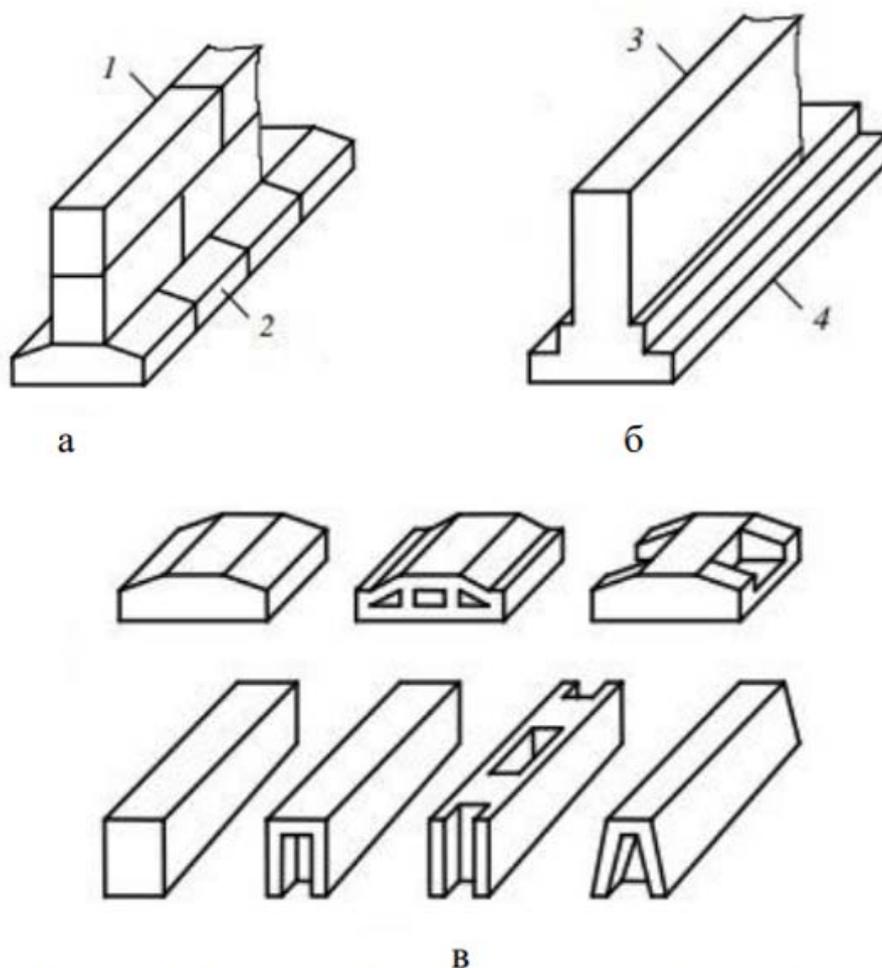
Стрічкові фундаменти: а – збірний безперевний;
